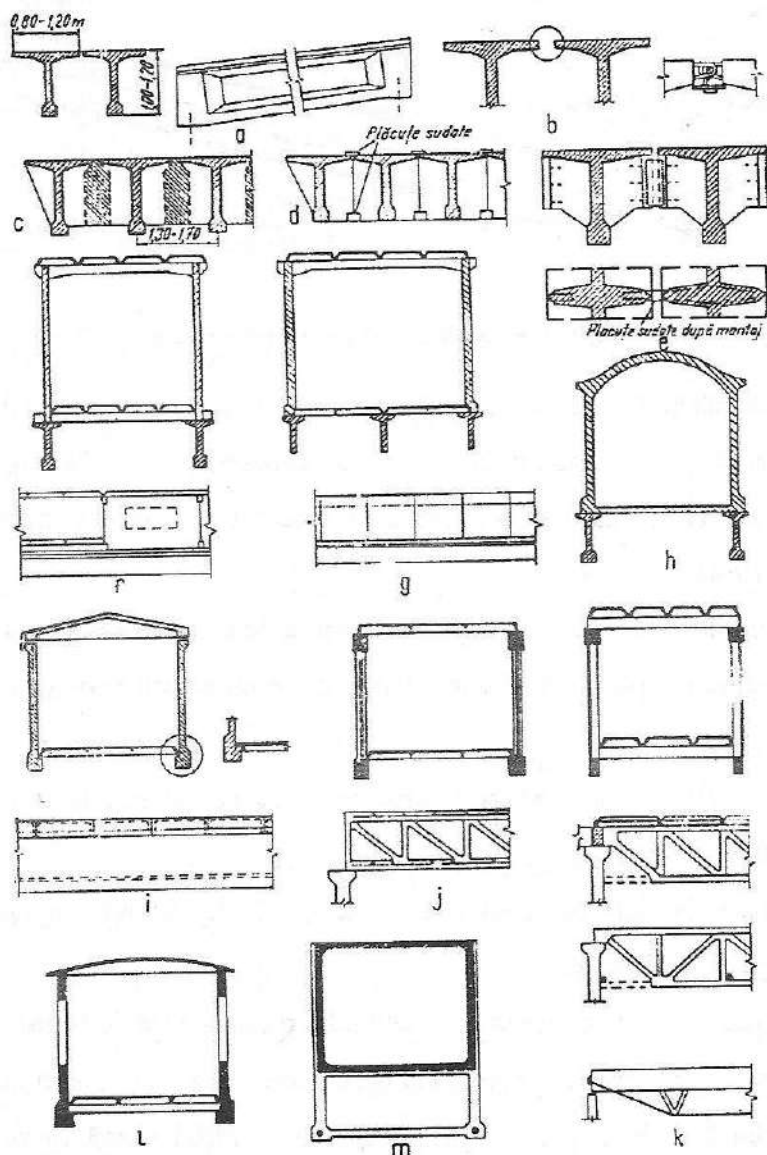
Secțiuni transversale de culoare din beton armat prefabricat:
